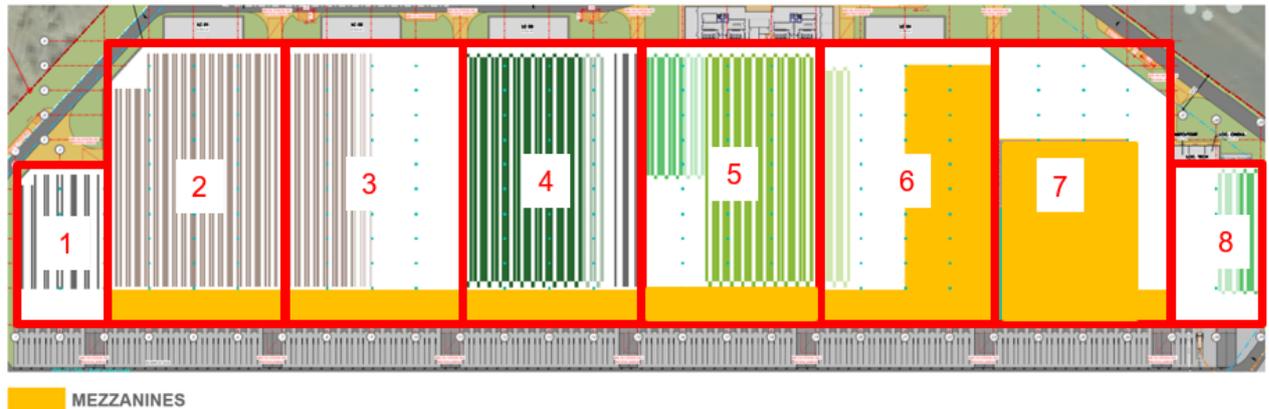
Plan de l'étage R+2 de la mezzanine
